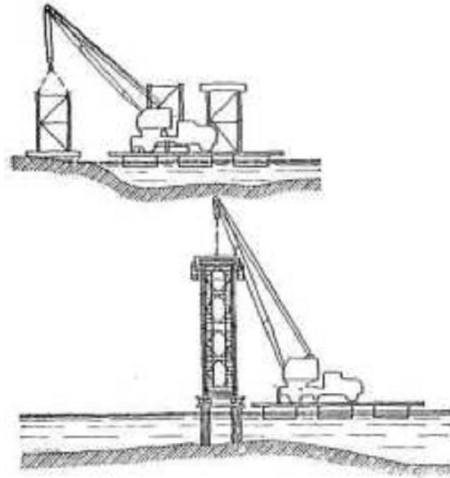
Монтаж промежуточной опоры из укрупненных блоков краном К-162 с парома
